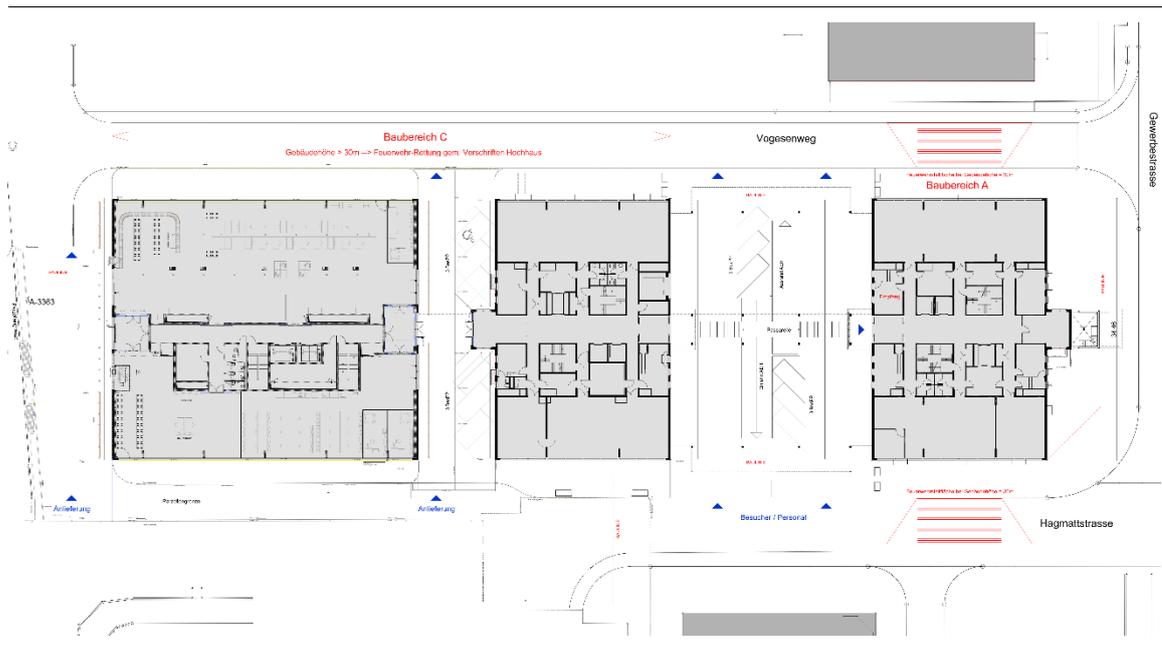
Plan Feuerwehrstellplätze (Quelle: Otto Partner Architekten AG)
